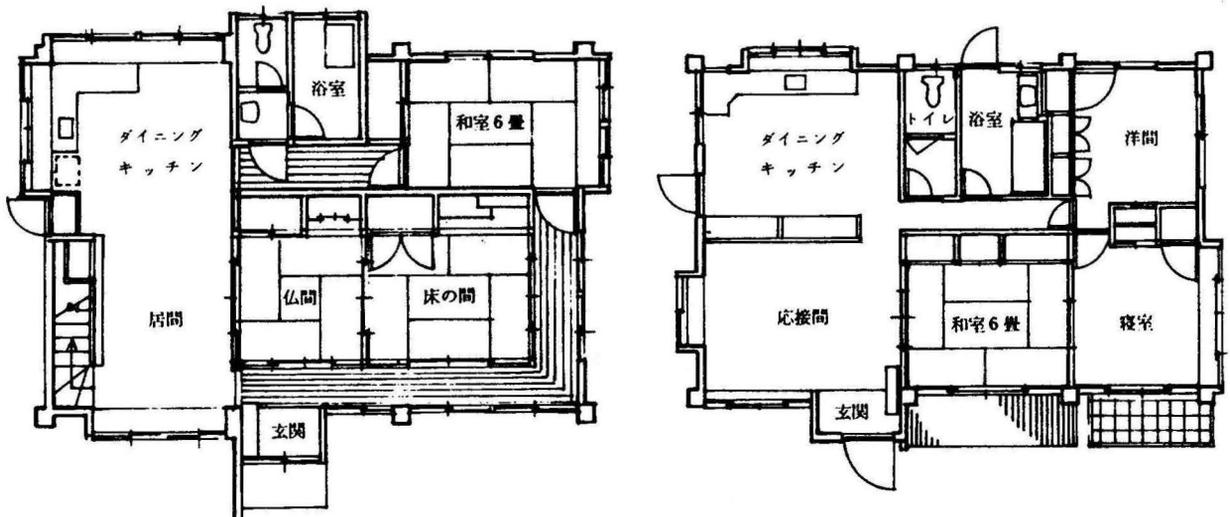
地元民間住宅の平面図（「居住風土のデザイン」より引用）
